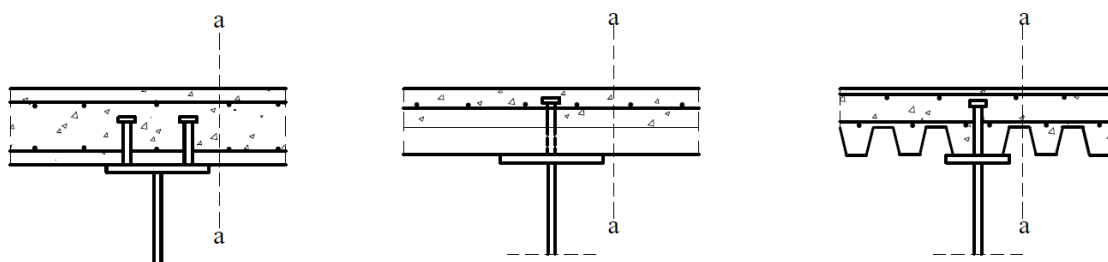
Vigas com laje em concreto acima da sua face superior. Fonte: ABNT/NBR-8800-2008
